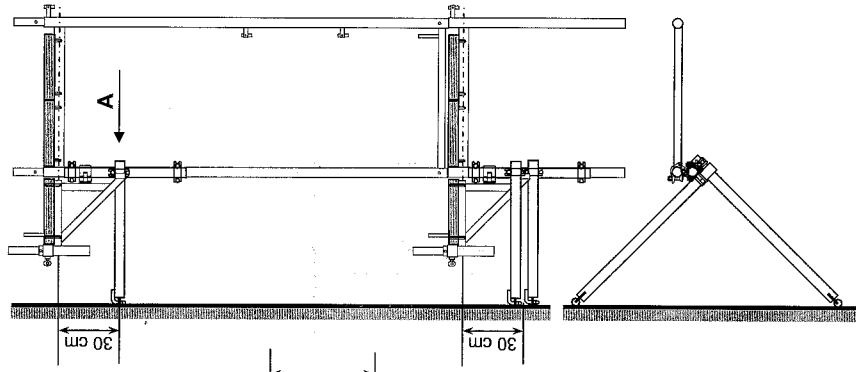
Gerüst mit Planenbekleidung, Verankerung unterhalb der „Knoten“
